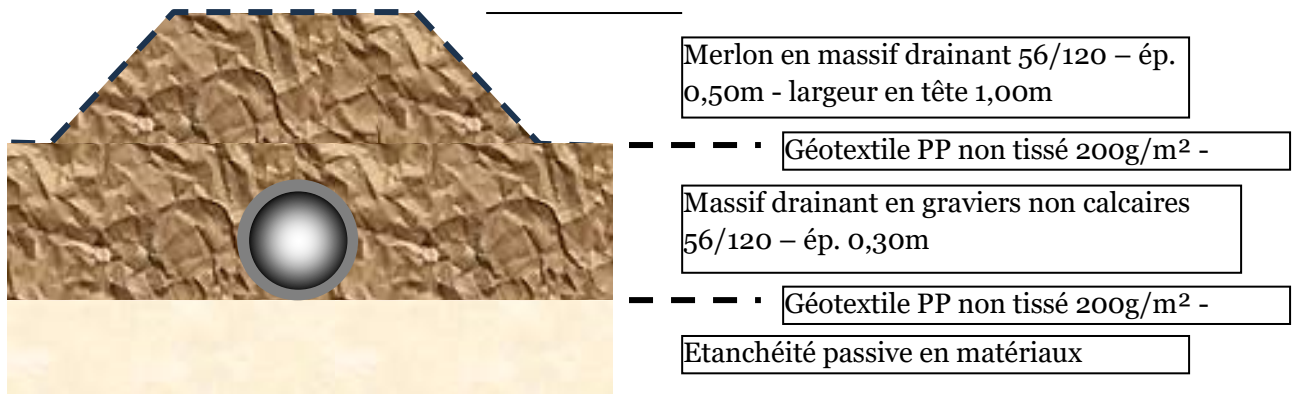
Coupe type pour canalisation de drainage des lixiviats en casier
